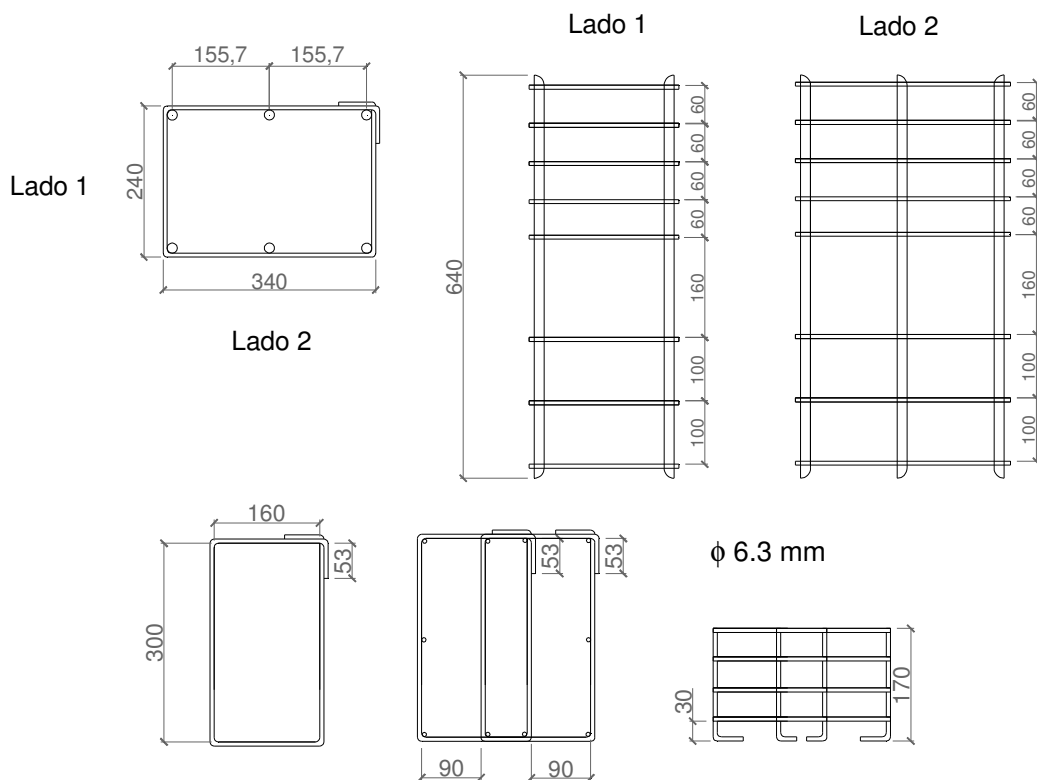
Detalhamento das armaduras para os modelos de chumbador sem fibras de aço (dimensões em mm)
